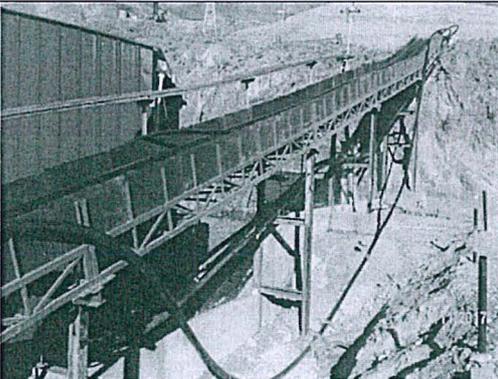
En las Coordenadas E 0344424 y N 8780775 se construyó una estructura metálica de contingencia para evitar derrame en el trayecto de las tuberías de relleno hidráulico.
